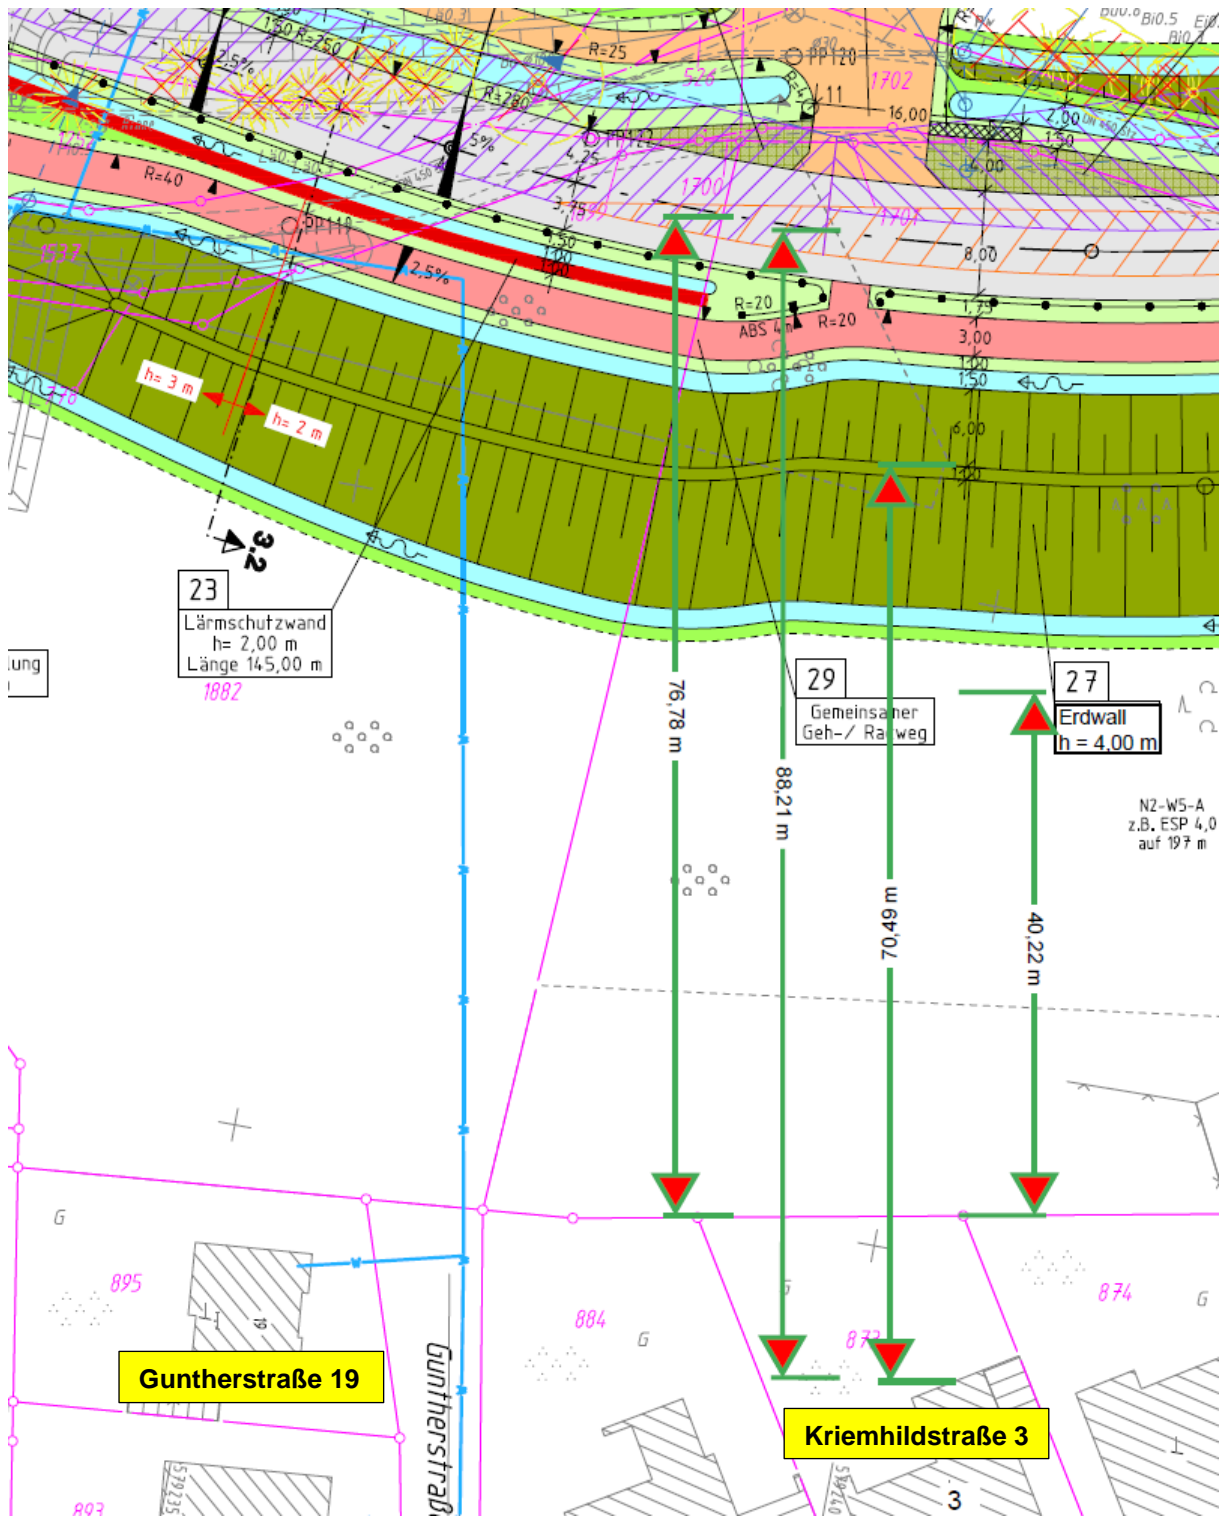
Lageplan: Grundstücke Kriemhildstraße 3 und Guntherstraße 19 mit den Entfernungen zur Achse der K 24n, zum Erdwall und zum Baufeld
